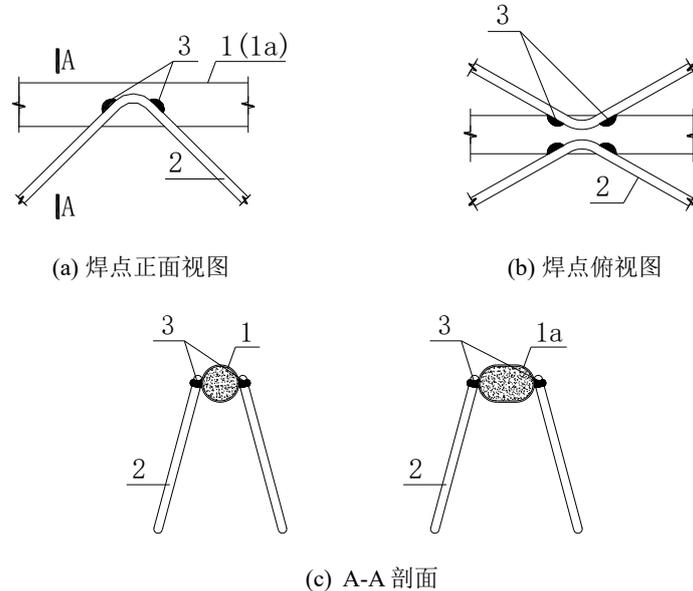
腹杆钢筋与钢管焊接示意
